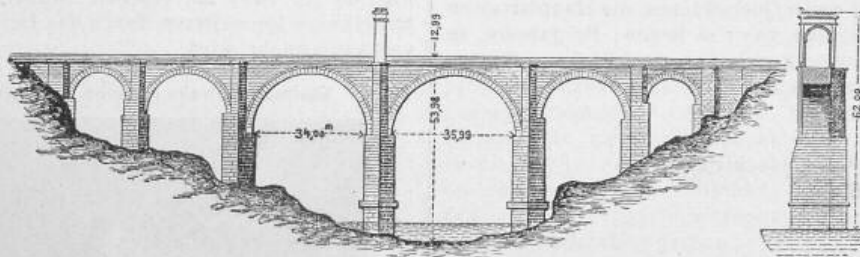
Ansicht und Schnitt der Brücke bei Alcantara. 1:2000.
